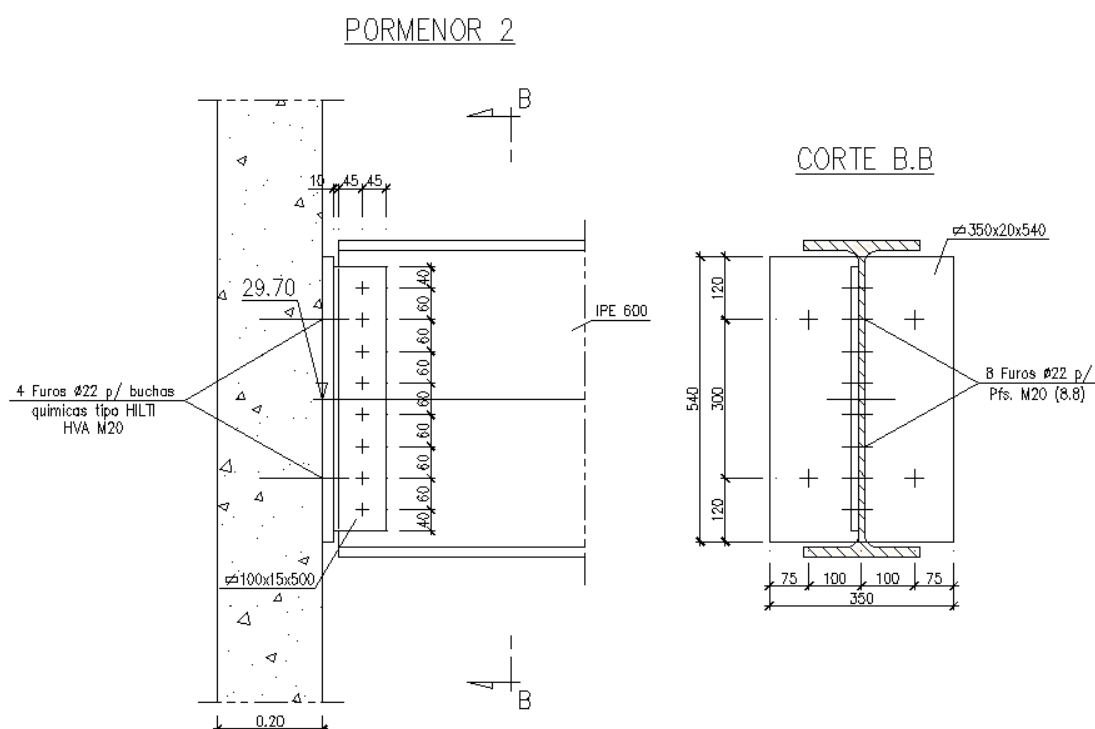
Viga metálica ligada a um elemento de betão através de um *gousset* e de uma chapa de extremidade (Cima Gomes; Biscaia, N., 2008)
